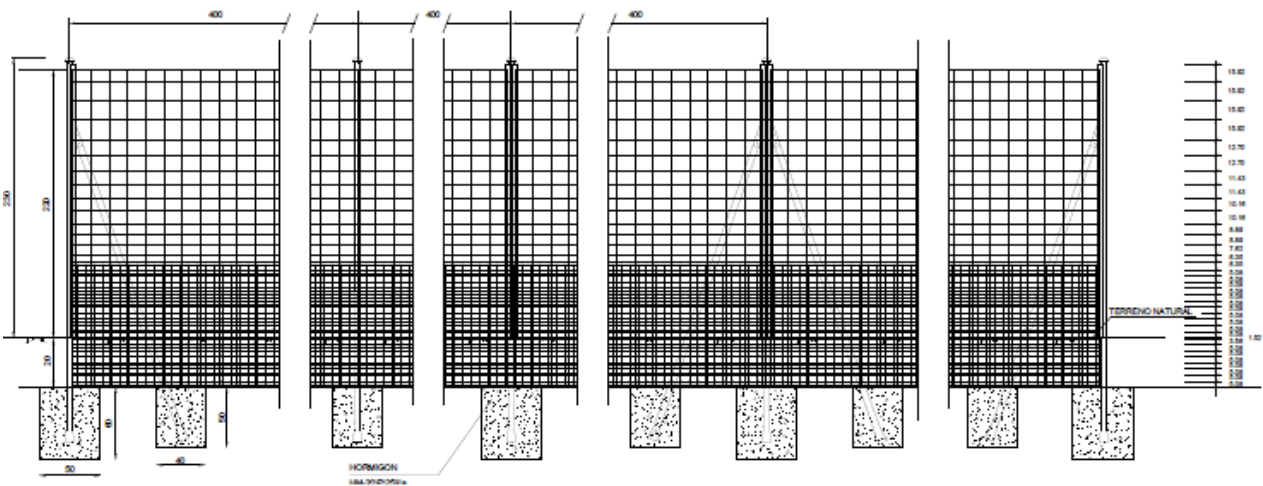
Vista frontal de cerramiento perimetral de obra
